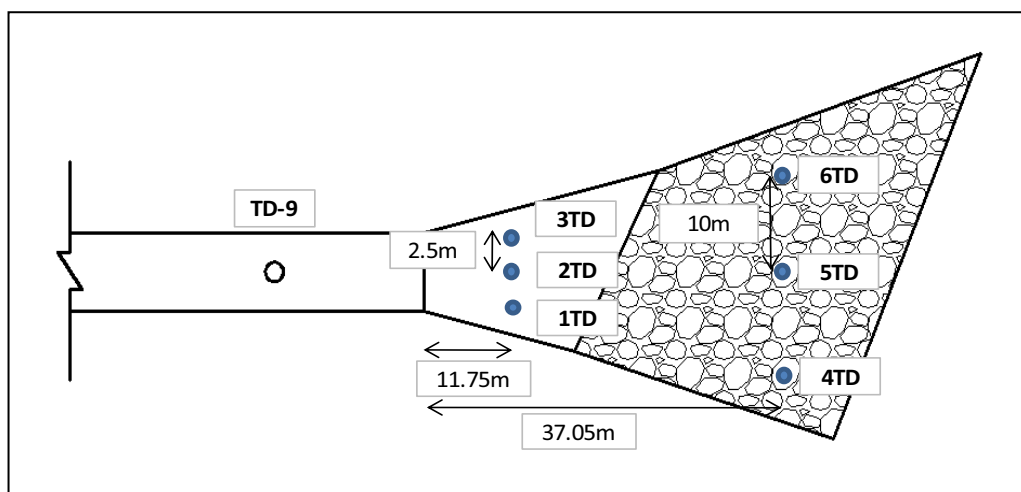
Vista en planta de la geometría propuesta para el diseño definitivo de la zona de entrega desde el Túnel de Desvío.
